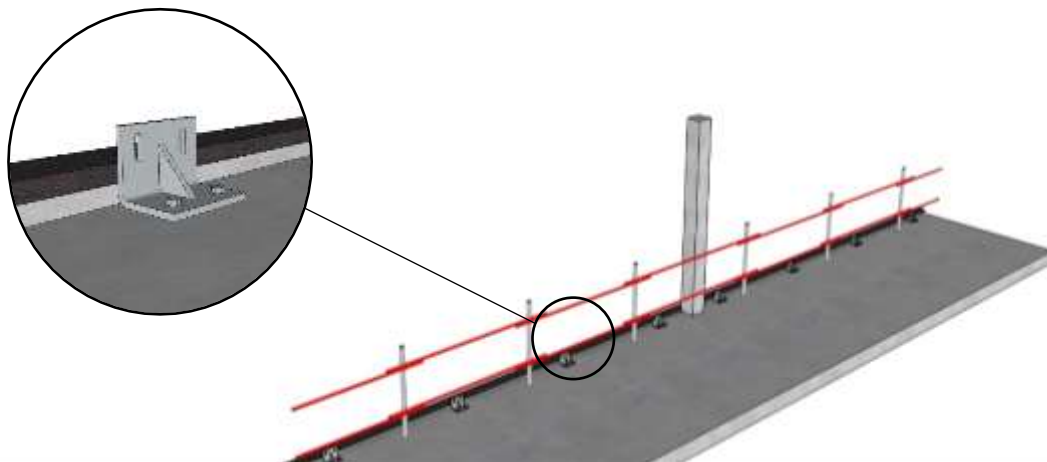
Mise en œuvre du mortier sur la semelle et fixation des équerres d'ancrage (FP3)
